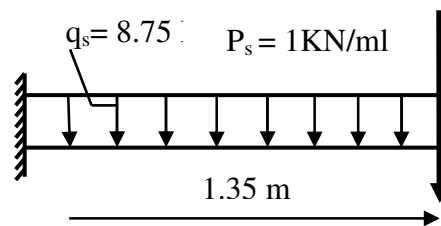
Schéma statique de la dalle pleine à l'ELS du balcon.
